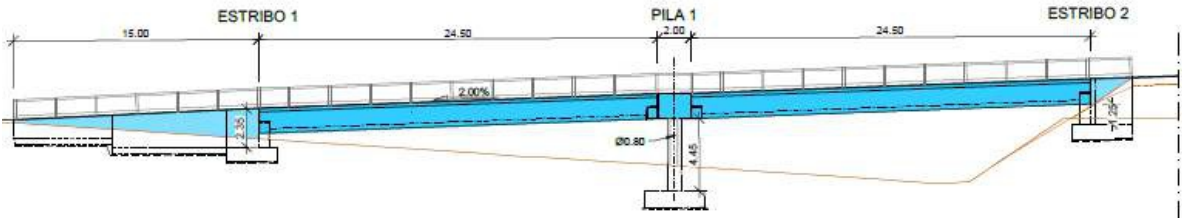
Sección longitudinal de la Pasarela P-3 en Alternativa 3B
